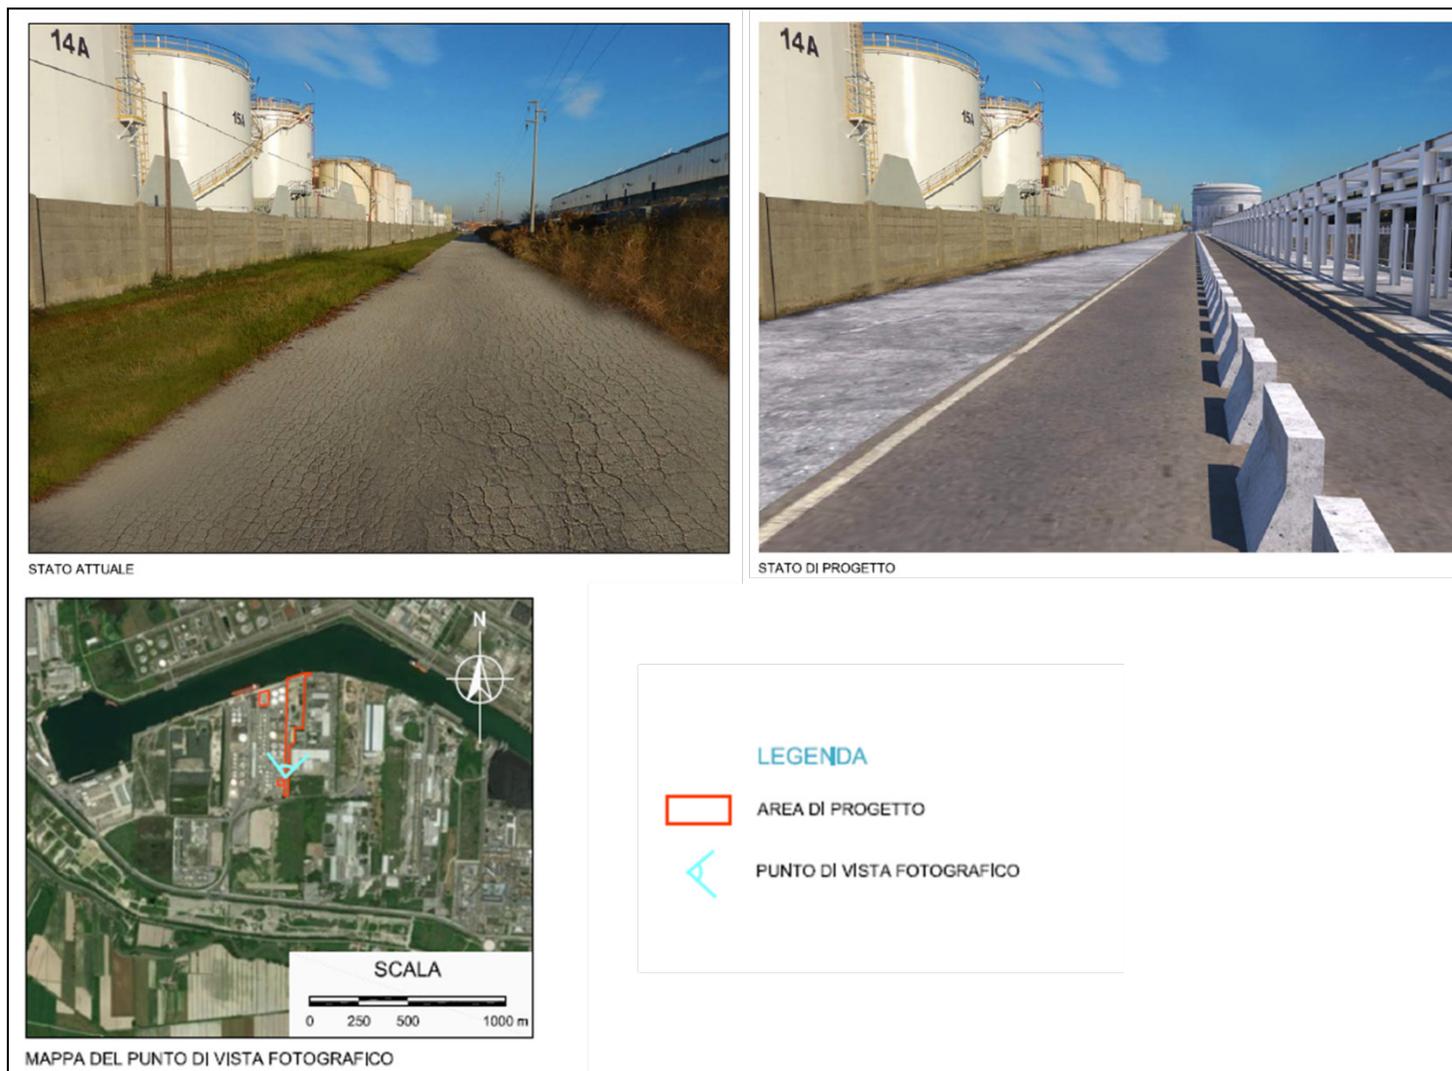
e: Fotoinserimento 3 (Deposito Costiero) - Vista dalla Strada di Accesso
